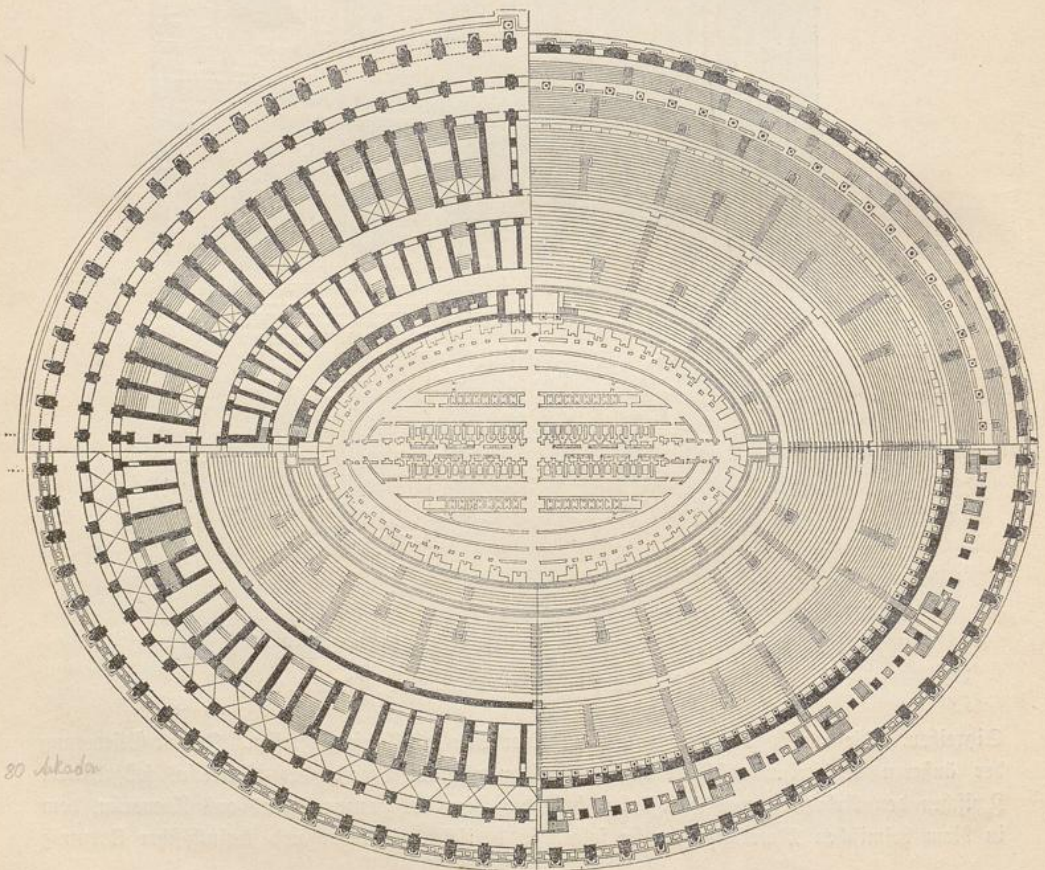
Kolosseum in Rom. Grundriß der vier Stockwerke.
